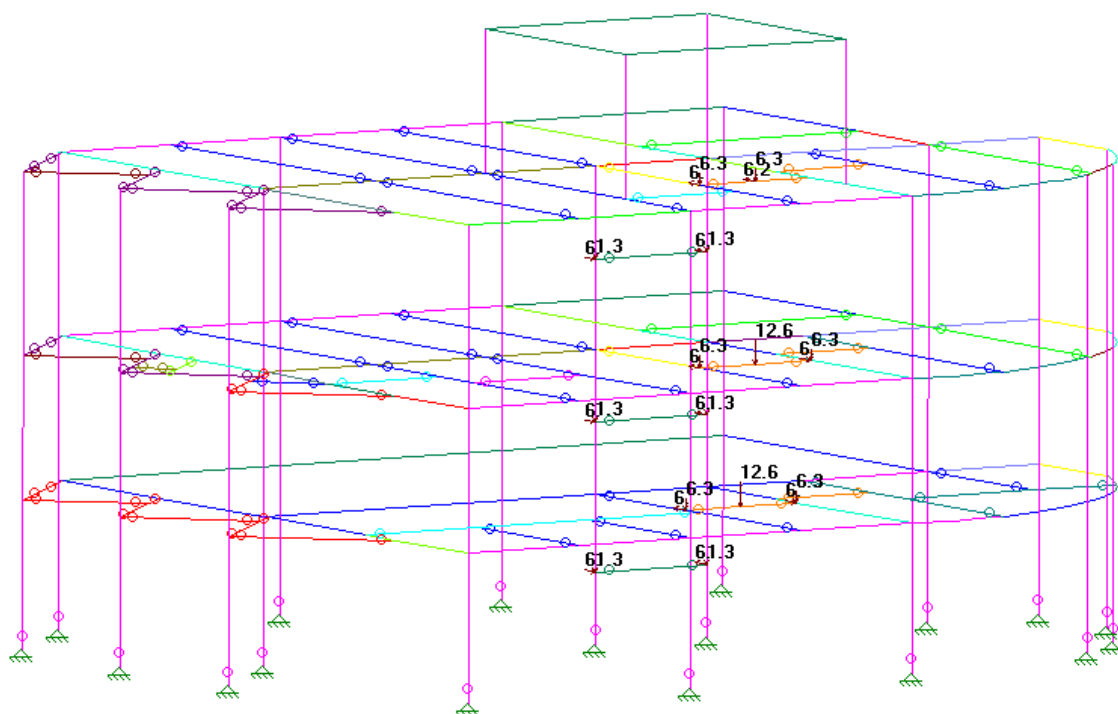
Sobrecarga das escadas – Carregamento aplicado
